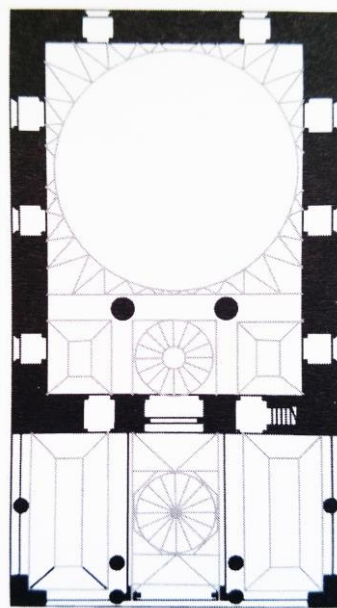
İbn-i Neccar Camii Planı [5]
